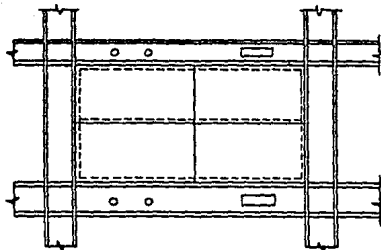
MURO DE CORTANTE CON PLACAS DE ACERO
